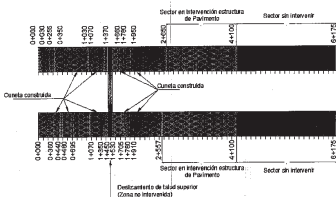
Avance construcción de cunetas Trayecto 6-1
